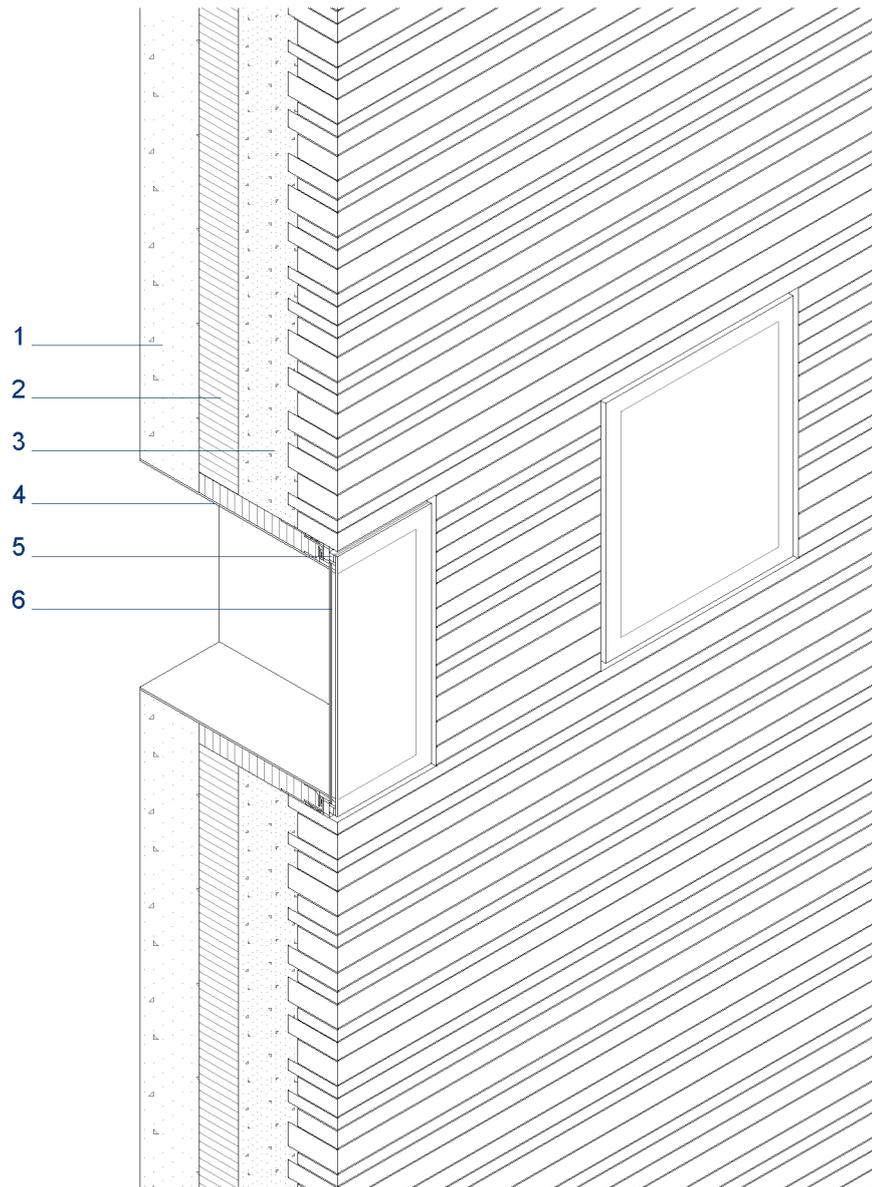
Axonometría E: 1/30. Detalle del muro de fachada.
